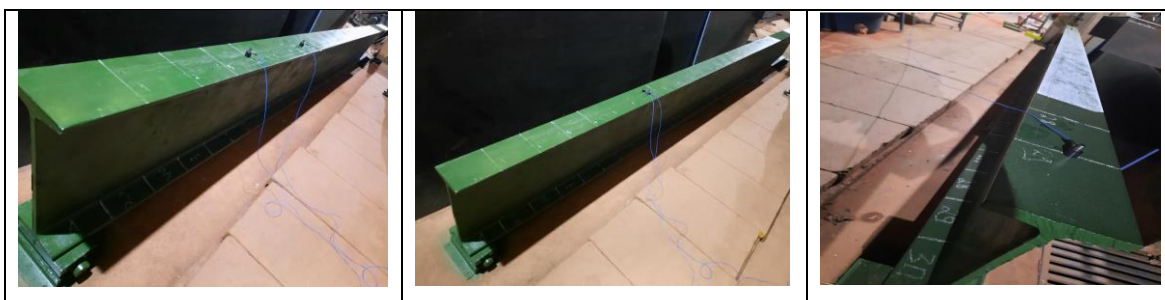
Repetição do ensaio modal da viga intacta metálica no dia 18/12/2020
